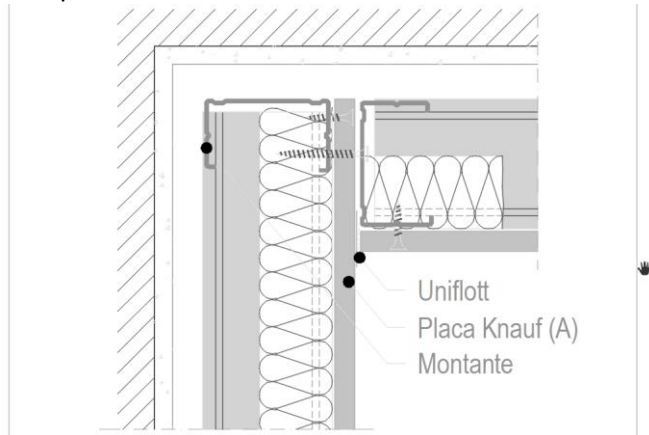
Sección trasdosado muro. www.knauf.es
